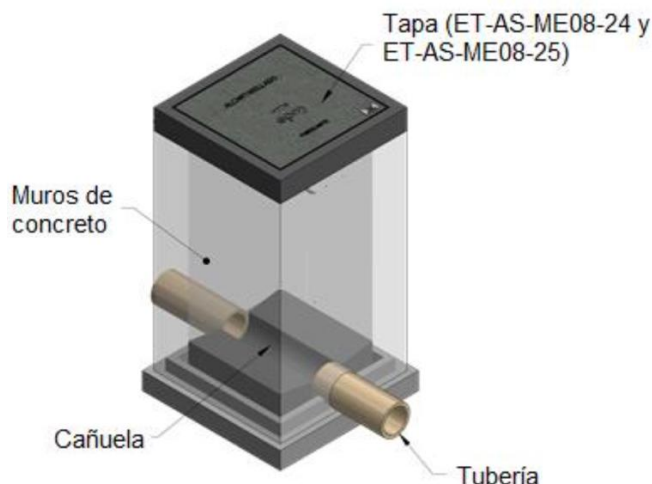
Caja de inspección. Fuente. EPM, 2019
